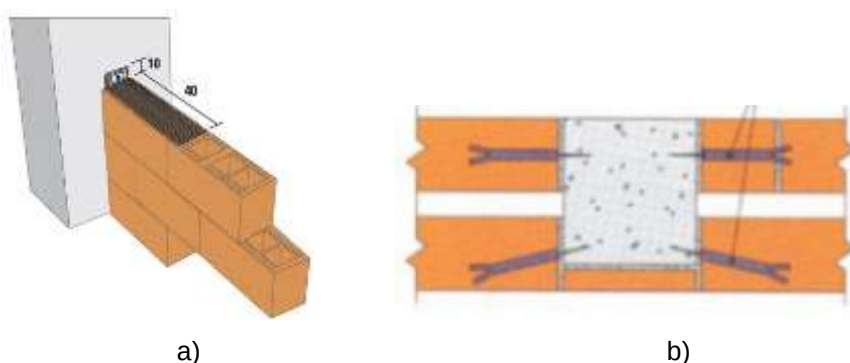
Exemplos de ligação entre parede de alvenaria e elemento de betão armado.
